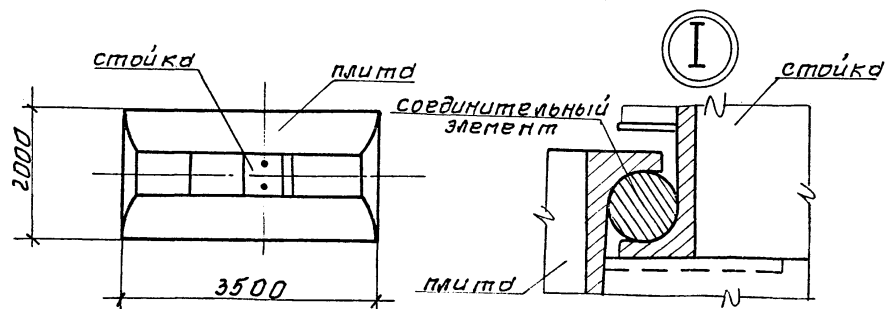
Конструкции унифицированных железобетонных элементов фундаментов
